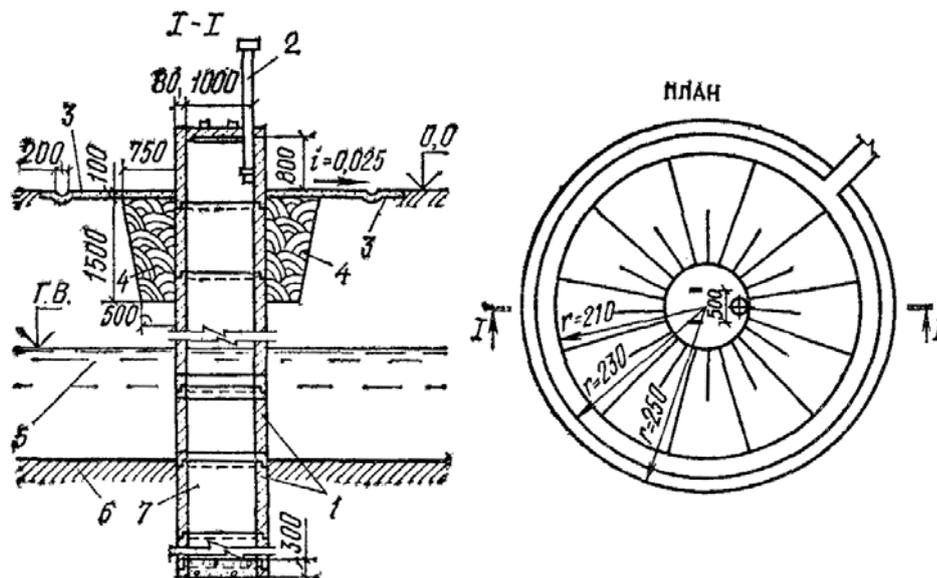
Конструкция совершенного шахтного колодца из сборных железобетонных колец
